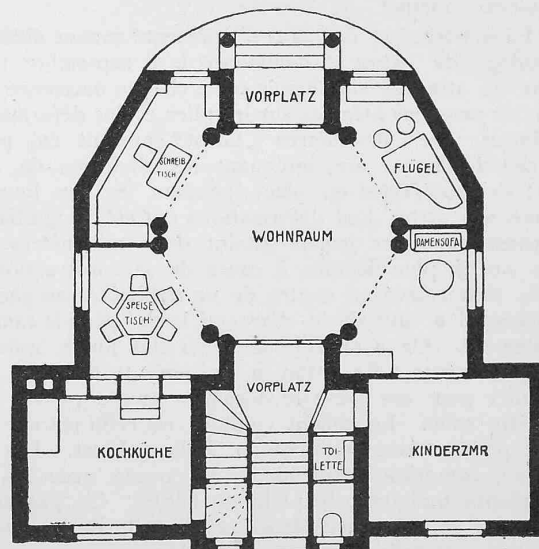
Grundriss vom Erdgeschoss des Landhaus-Entwurfs von Prof. Behrens. — Masstab 1:200.
